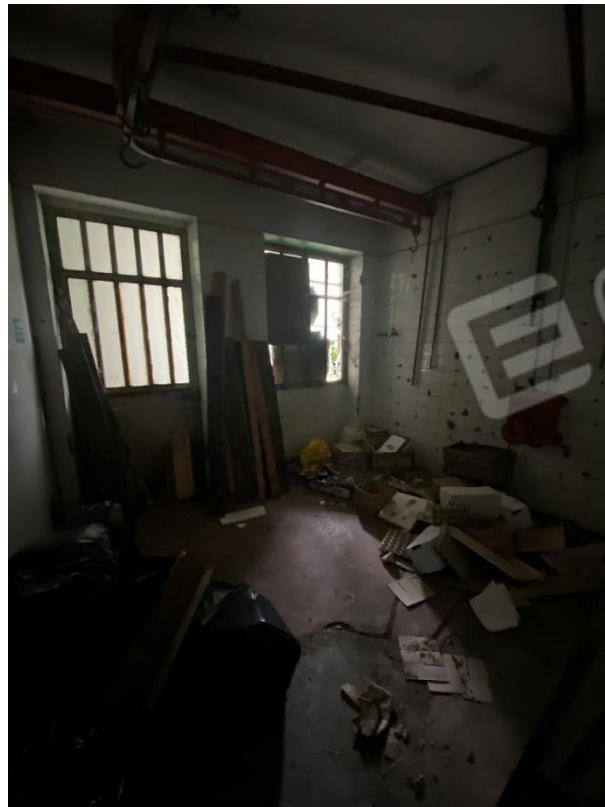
VISTA INTERNA LOCALI DI SGOMBERO PIANO SEMINTERRATO
